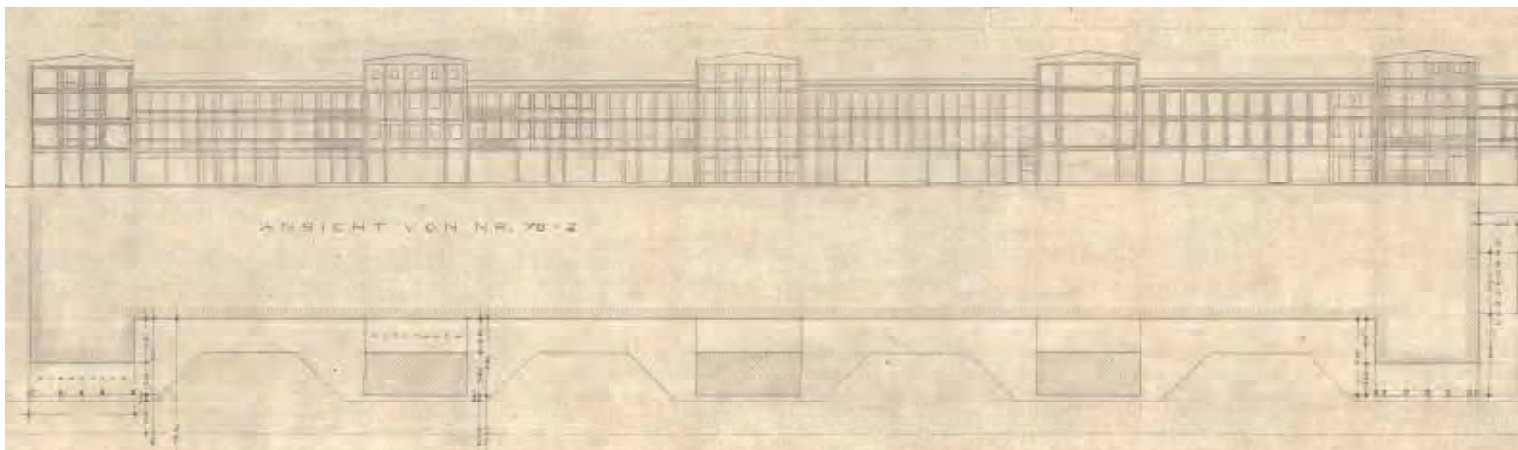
Ansicht und Schemagrundriss Hauptstraße, dat. 19.2.1948, Ausschnitt Südseite (Quelle: HA Erzbistum Köln, PK 170)
